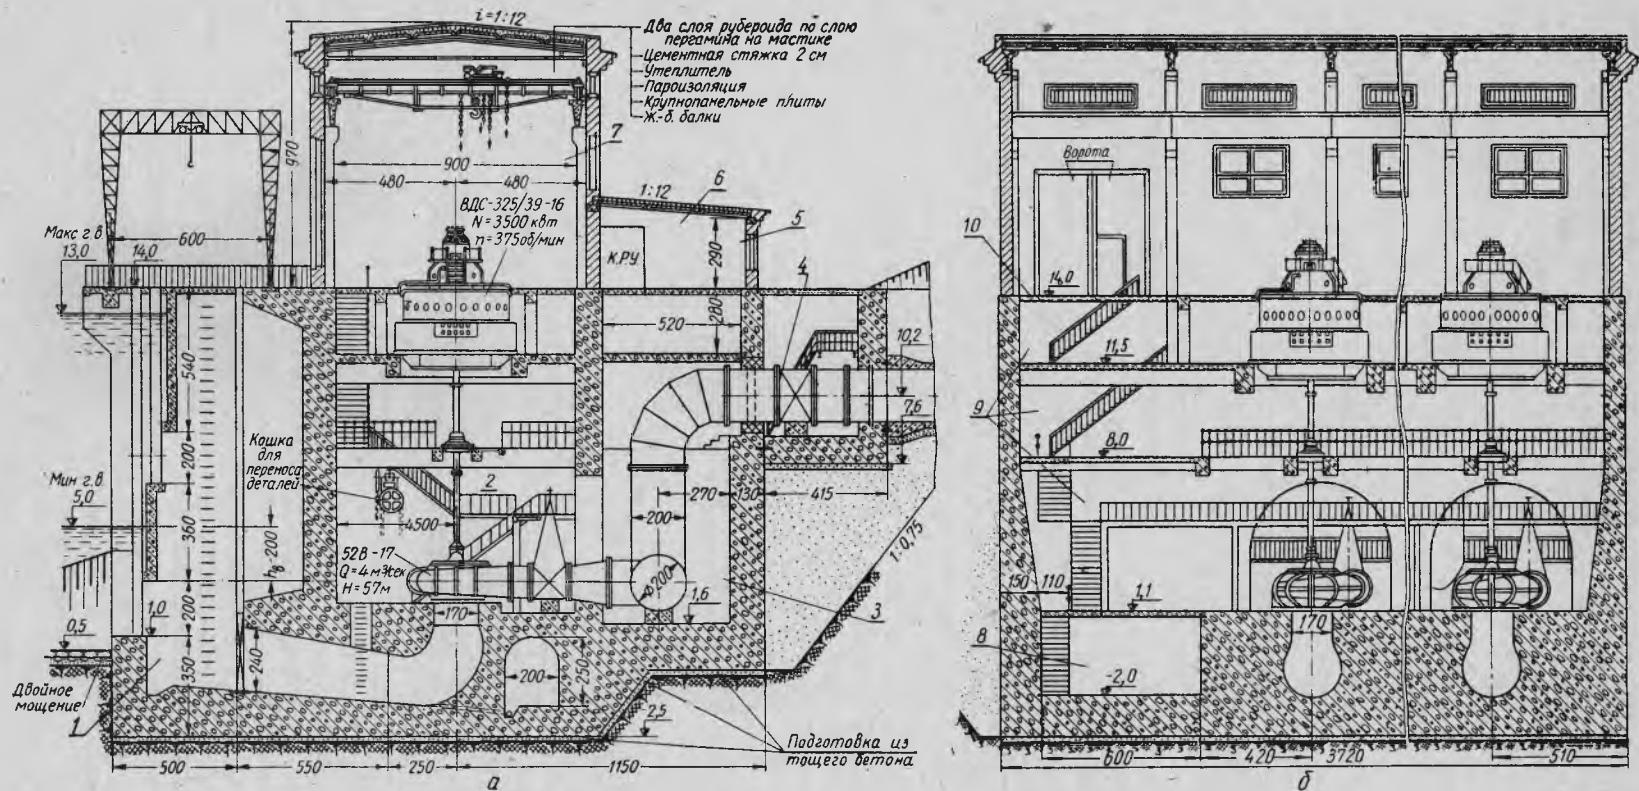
Расположение здания КРУ и ЩУ над напорными трубопроводами:
